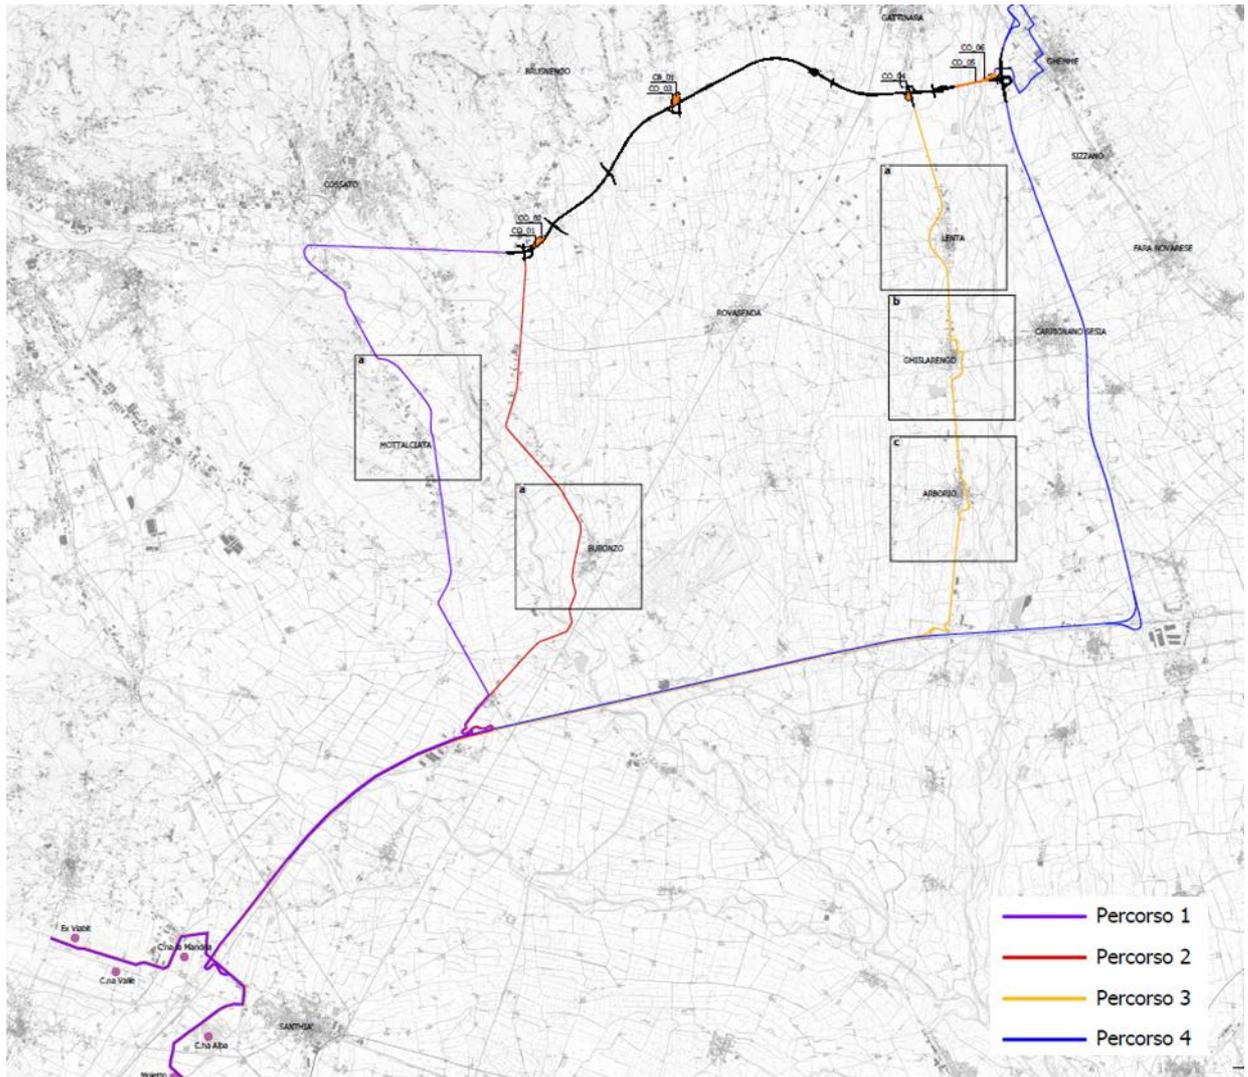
Percorsi previsti per l'approvvigionamento del materiale dai mezzi di cantiere – stralcio elaborato "Cantierizzazione: ubicazione delle aree di cantiere e viabilità di servizio"
